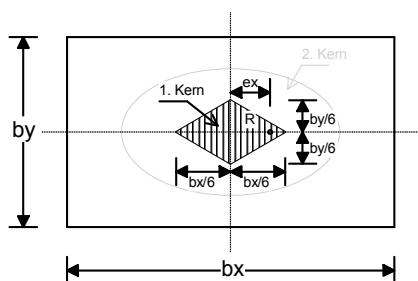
Grundriss eines rechteckigen Fundamentes; Begrenzung der 1. Kernweite
